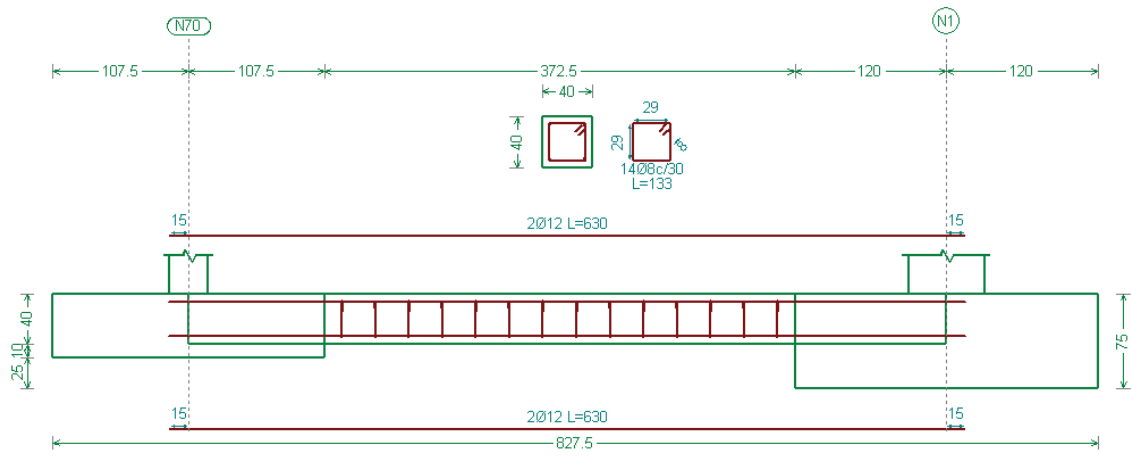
Armado viga riostra zapata hastial-zapata pilarillo
